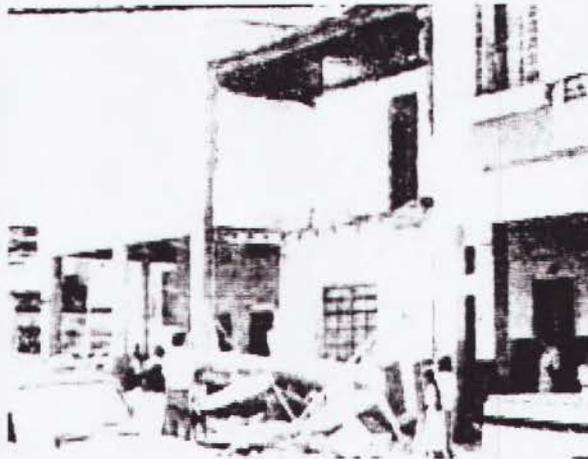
Derrumbes de fachadas de casas mixtas.
